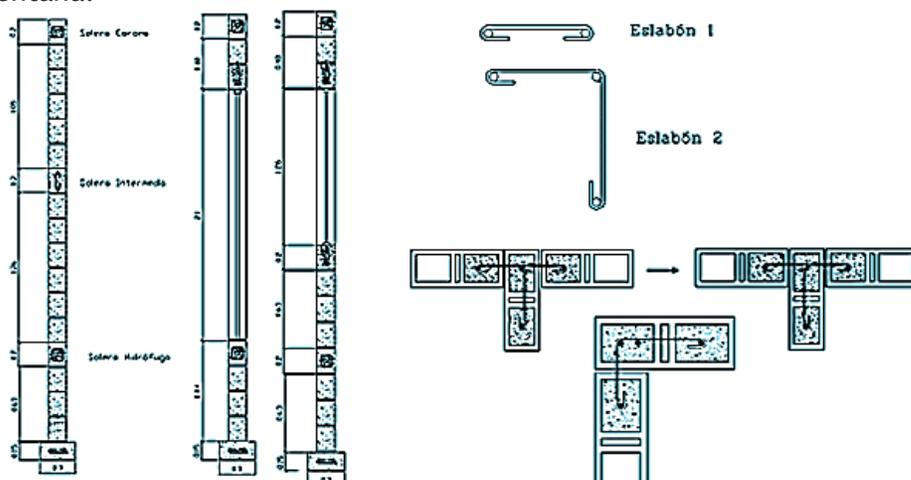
Secciones y detalles de ejemplos de soleras y columnas de mampostería reforzada. (Florián E. pp.149.152).
